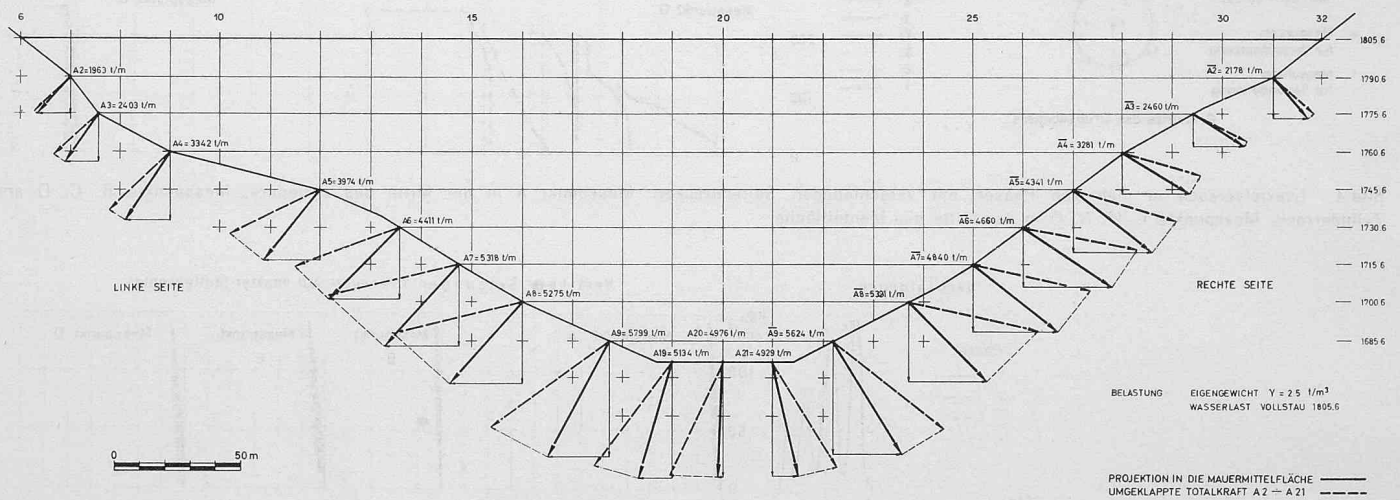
Felsbelastung längs der Auflagerfläche einer Bogenstaumauer, Abwicklung
